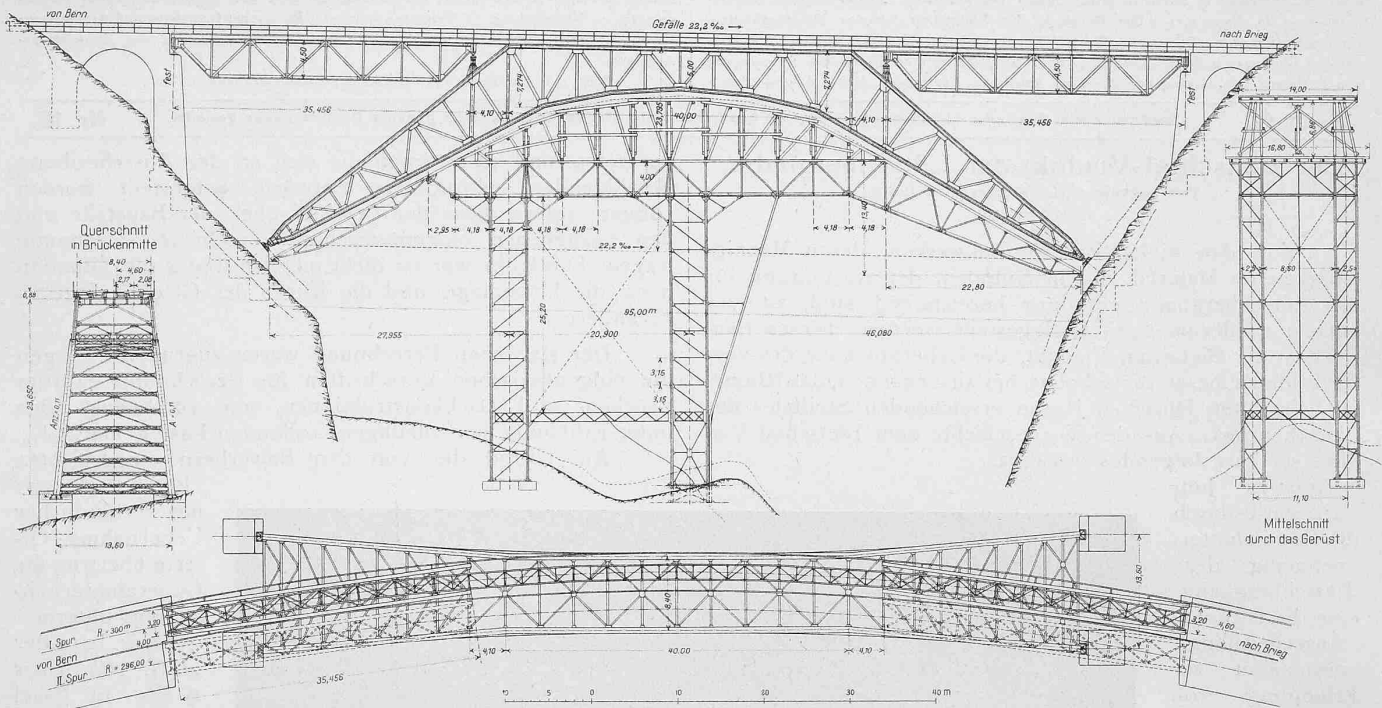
Gesamtansicht, Grundriss und Querschnitt der Brücke, Ansicht und Querschnitt des Gerüsts. — Masstab 1 : 800.
